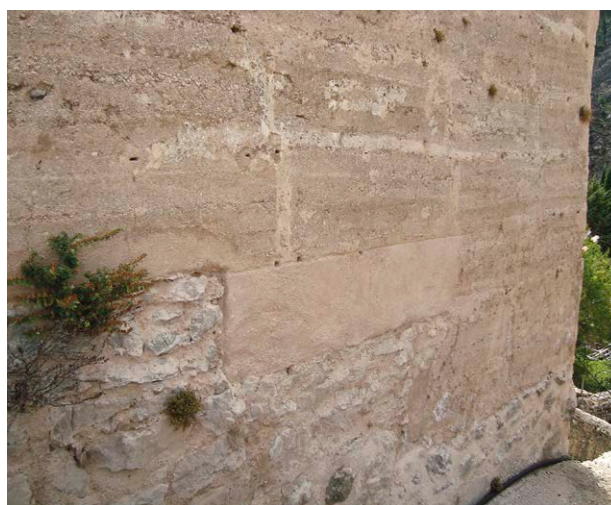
Muro de tapia sobre basamento de mampostería que se adapta a la pendiente del terreno sobre el que apoya
